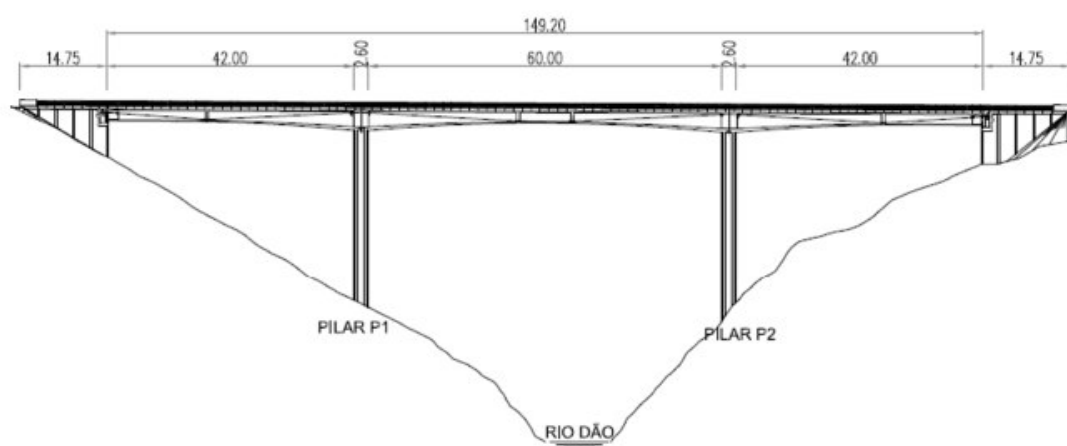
Perfil longitudinal da Ponte de Fagilde
